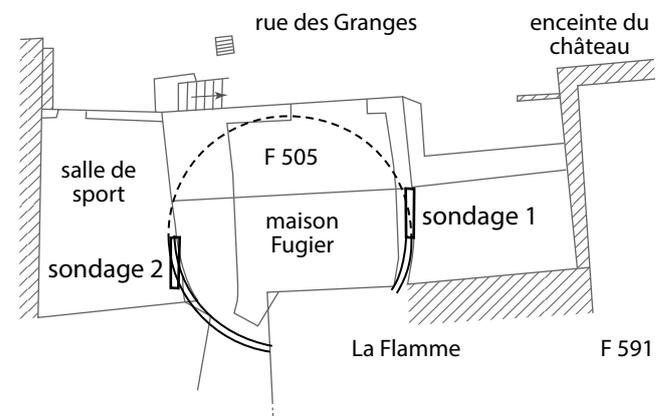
MONTMAUR, maison Fugier. Schéma des vestiges de la tour nord-ouest du château du village, pris dans la maison Fugier sur le relevé topographique Toulemonde-Bontoux 2013. Au niveau du sondage 1, le parement extérieur est intègre alors que le parement interne n'existe plus. Le pourtour de la tour est conservé au niveau du sondage 2. Au-delà des sondages, les murs sont encore, semble-t-il, conservés et prolongés par les constructions plus récentes avec lesquelles ils se confondent (L. Pinet / CARA-MMd 05).
